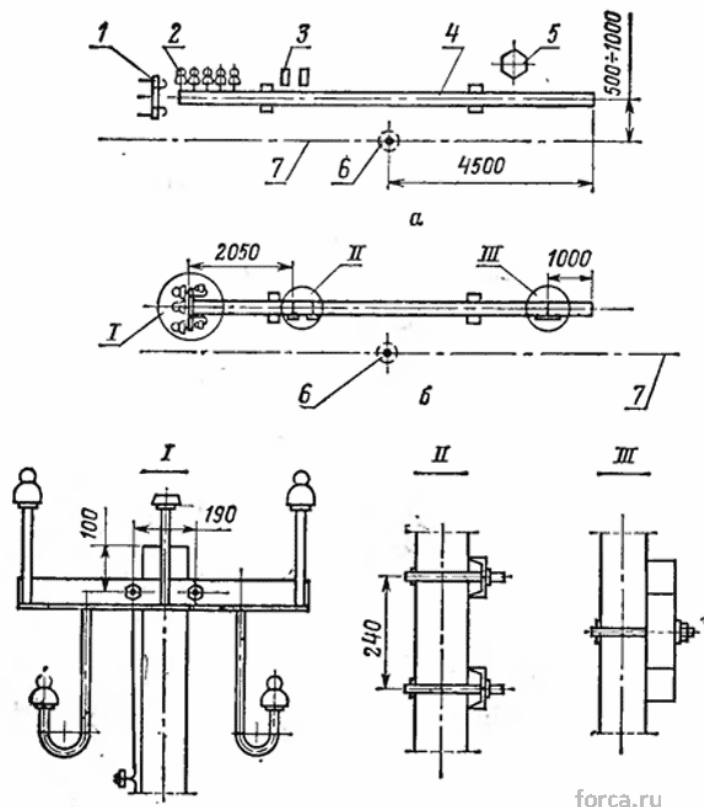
Сборка железобетонной ответвительной опоры ОП-0,4:
